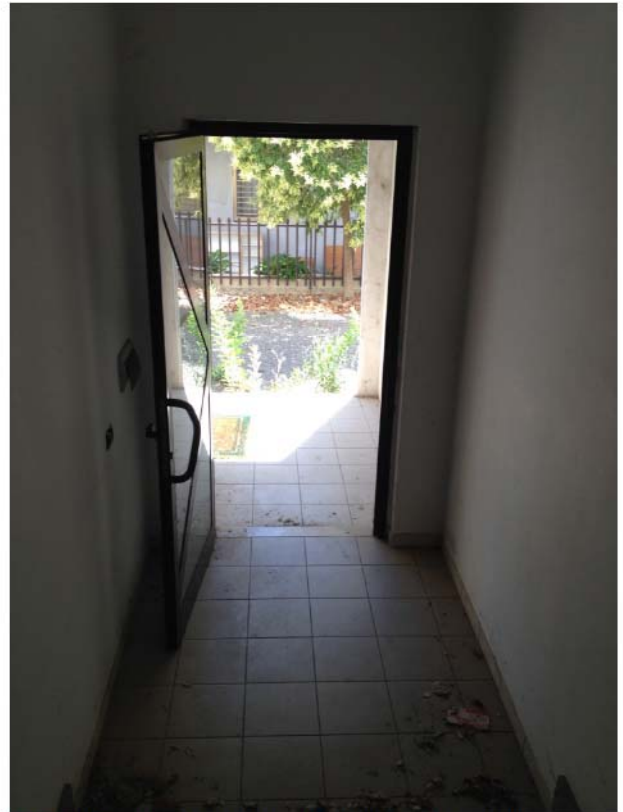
camera 2 appartamento 1 al primo piano)
